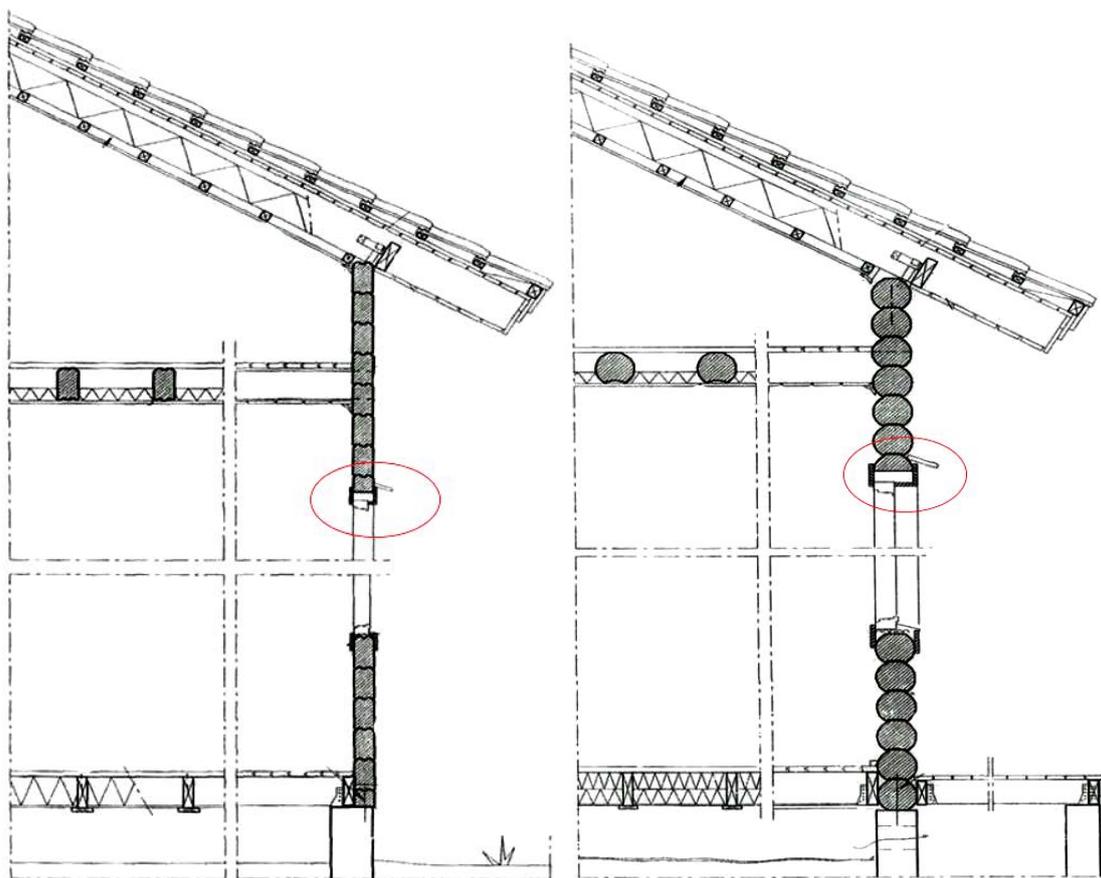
Вертикальный разрез сруба со стенами из бруса и бревна
